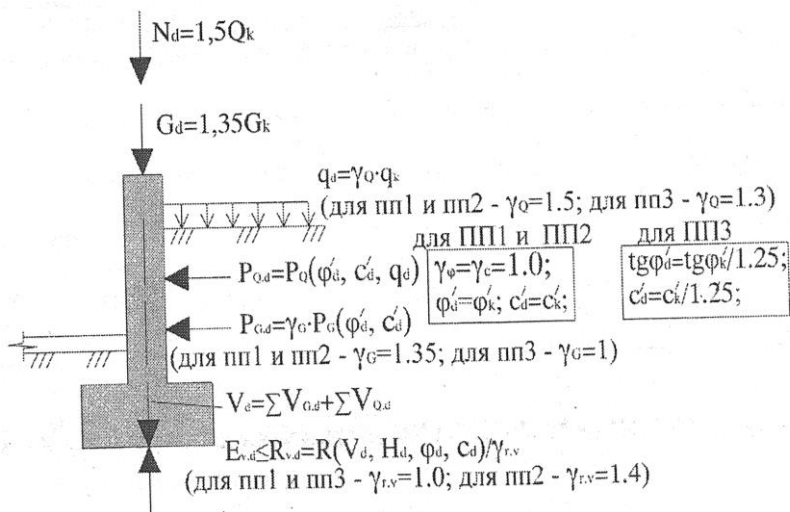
Принципиальная схема расчета STR, GEO оснований фундаментов с использованием проектных подходов ПП 1 – ПП 3 (DA 1 – DA 3) на примере проектирования плитных фундаментов по частным коэффициентам (вариант вертикального равновесия при неблагоприятных сочетаниях воздействий)
